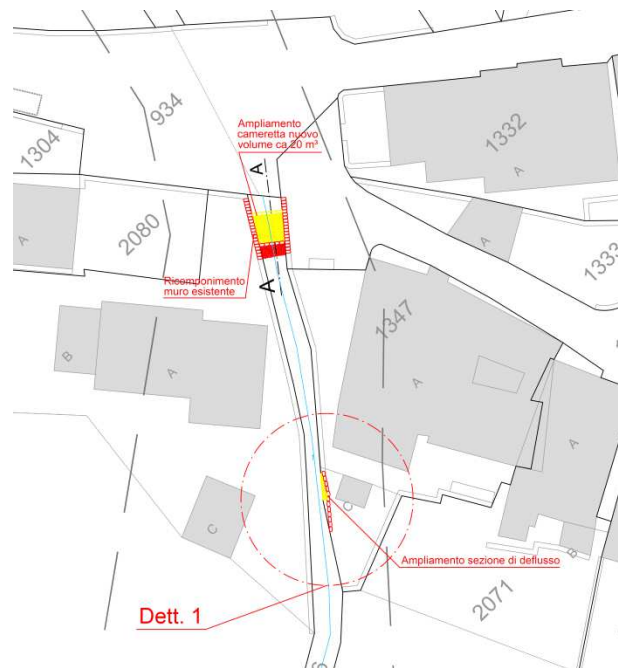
Planimetria dell'ampiamiento della camera e del sezione di deflusso.
